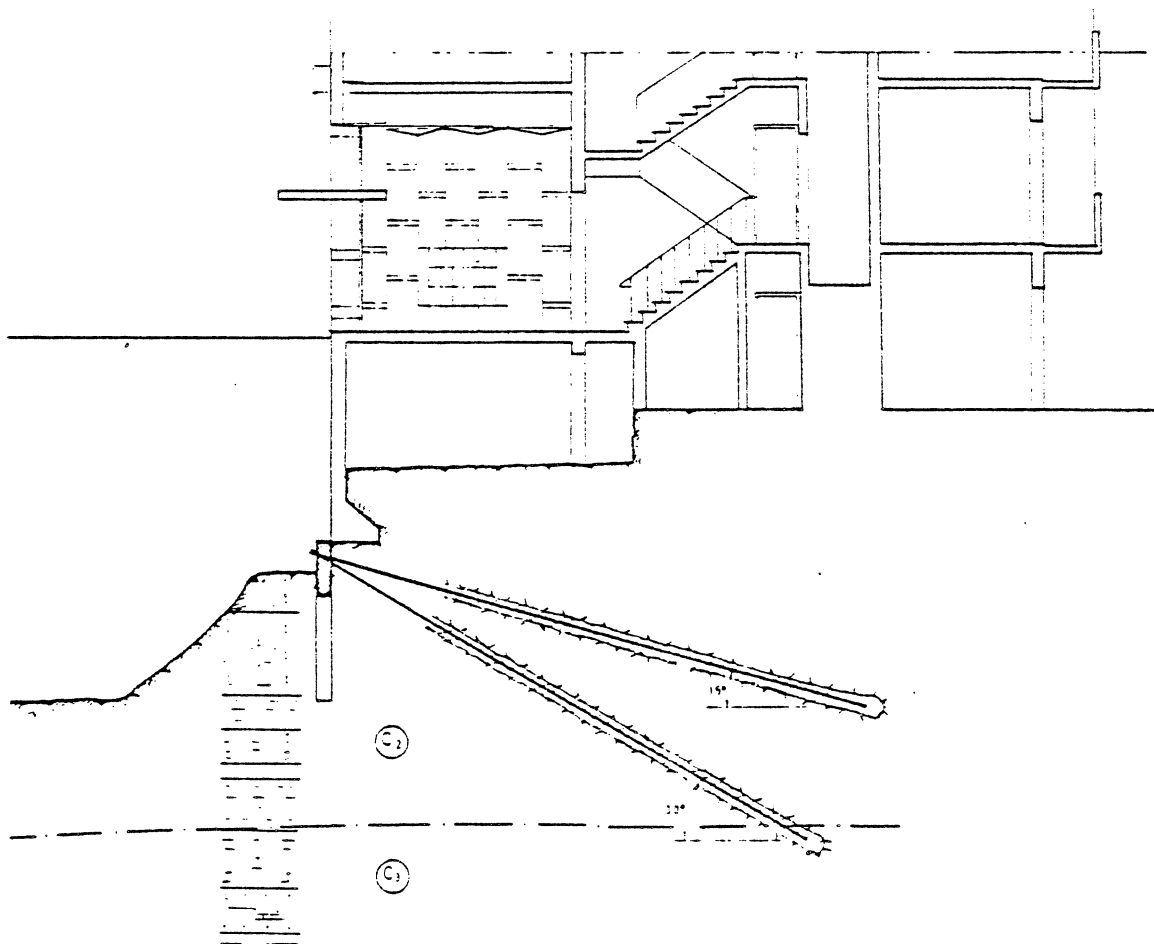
Ancoragens para sustentação do terreno de fundação do prédio
